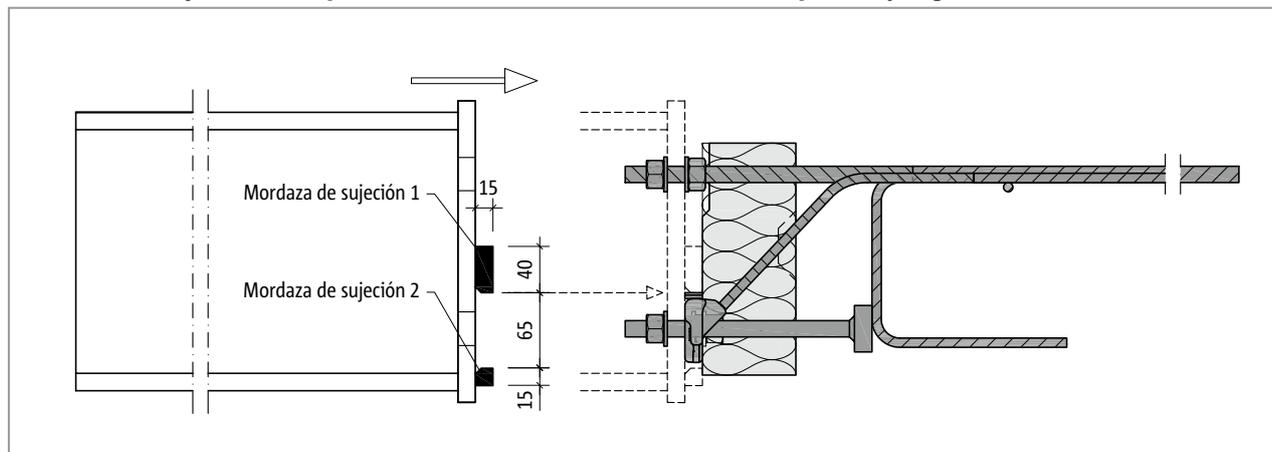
Schöck Isokorb® T tipo SK: Montaje de la viga de acero
